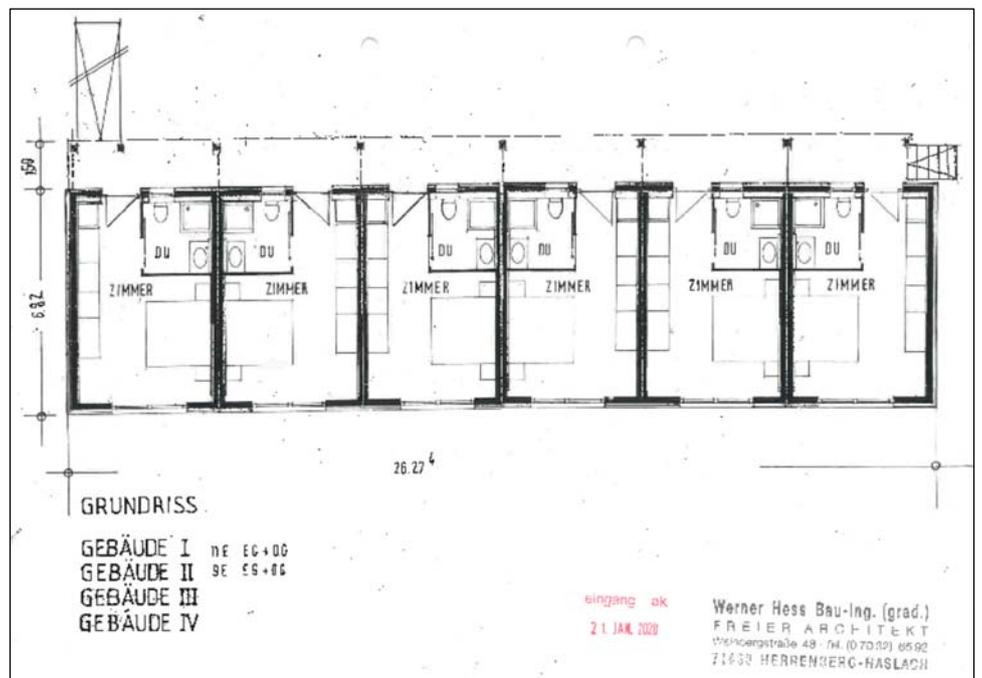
Grundriss Zimmermodule - Digital Hotel
